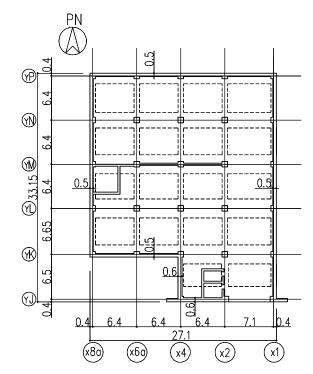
地下2階平面図 (G.L.-8.7) (単位:m)
